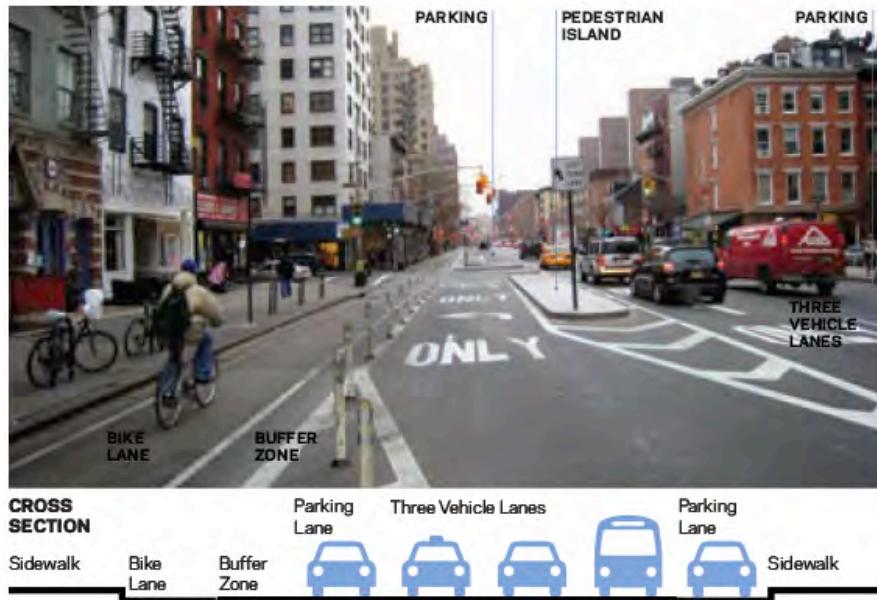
“Rue complète” sur la 9e Avenue, île de Manhattan, New York
